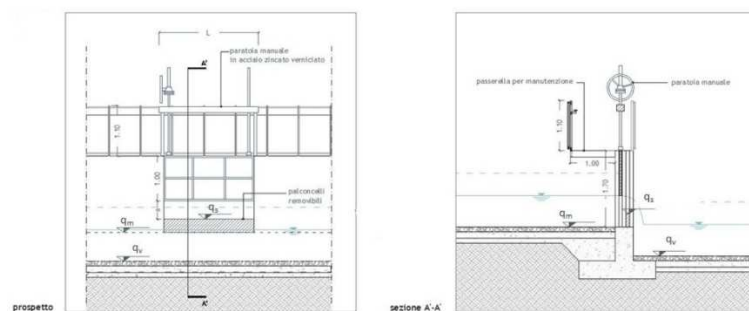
Prospetto e sezione briglia di regolazione canale perimetrale
